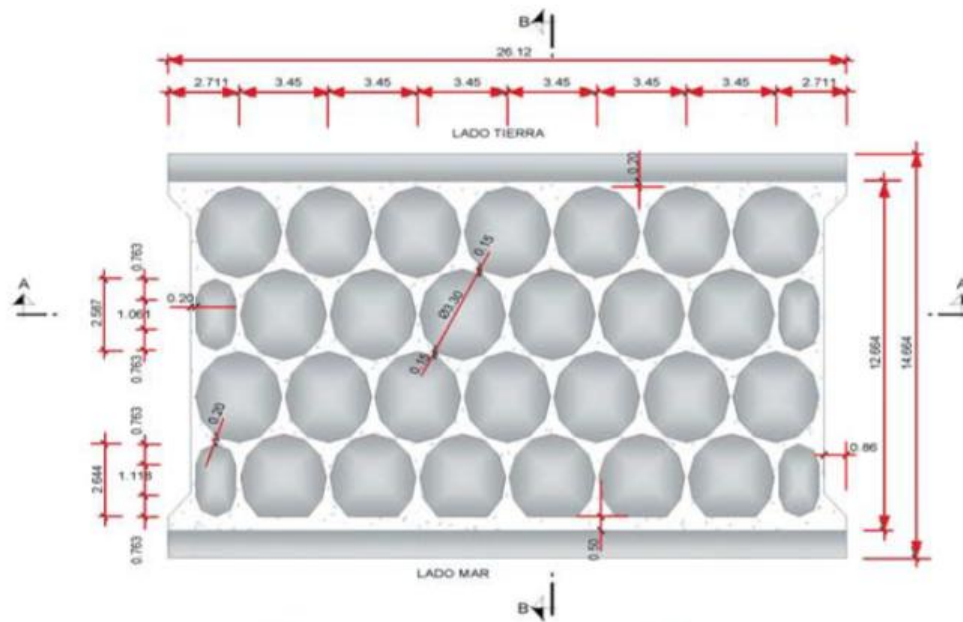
Ejemplo de cajón flotante de hormigón en planta [1]
